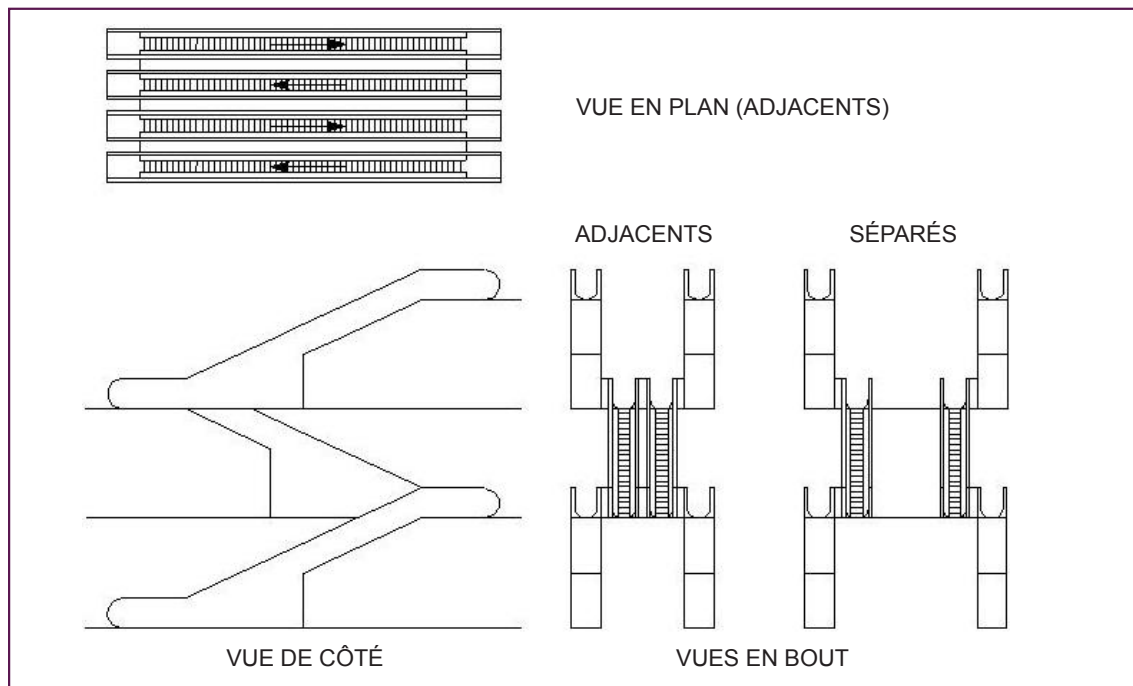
Disposition en parallèle d'escaliers mécaniques
